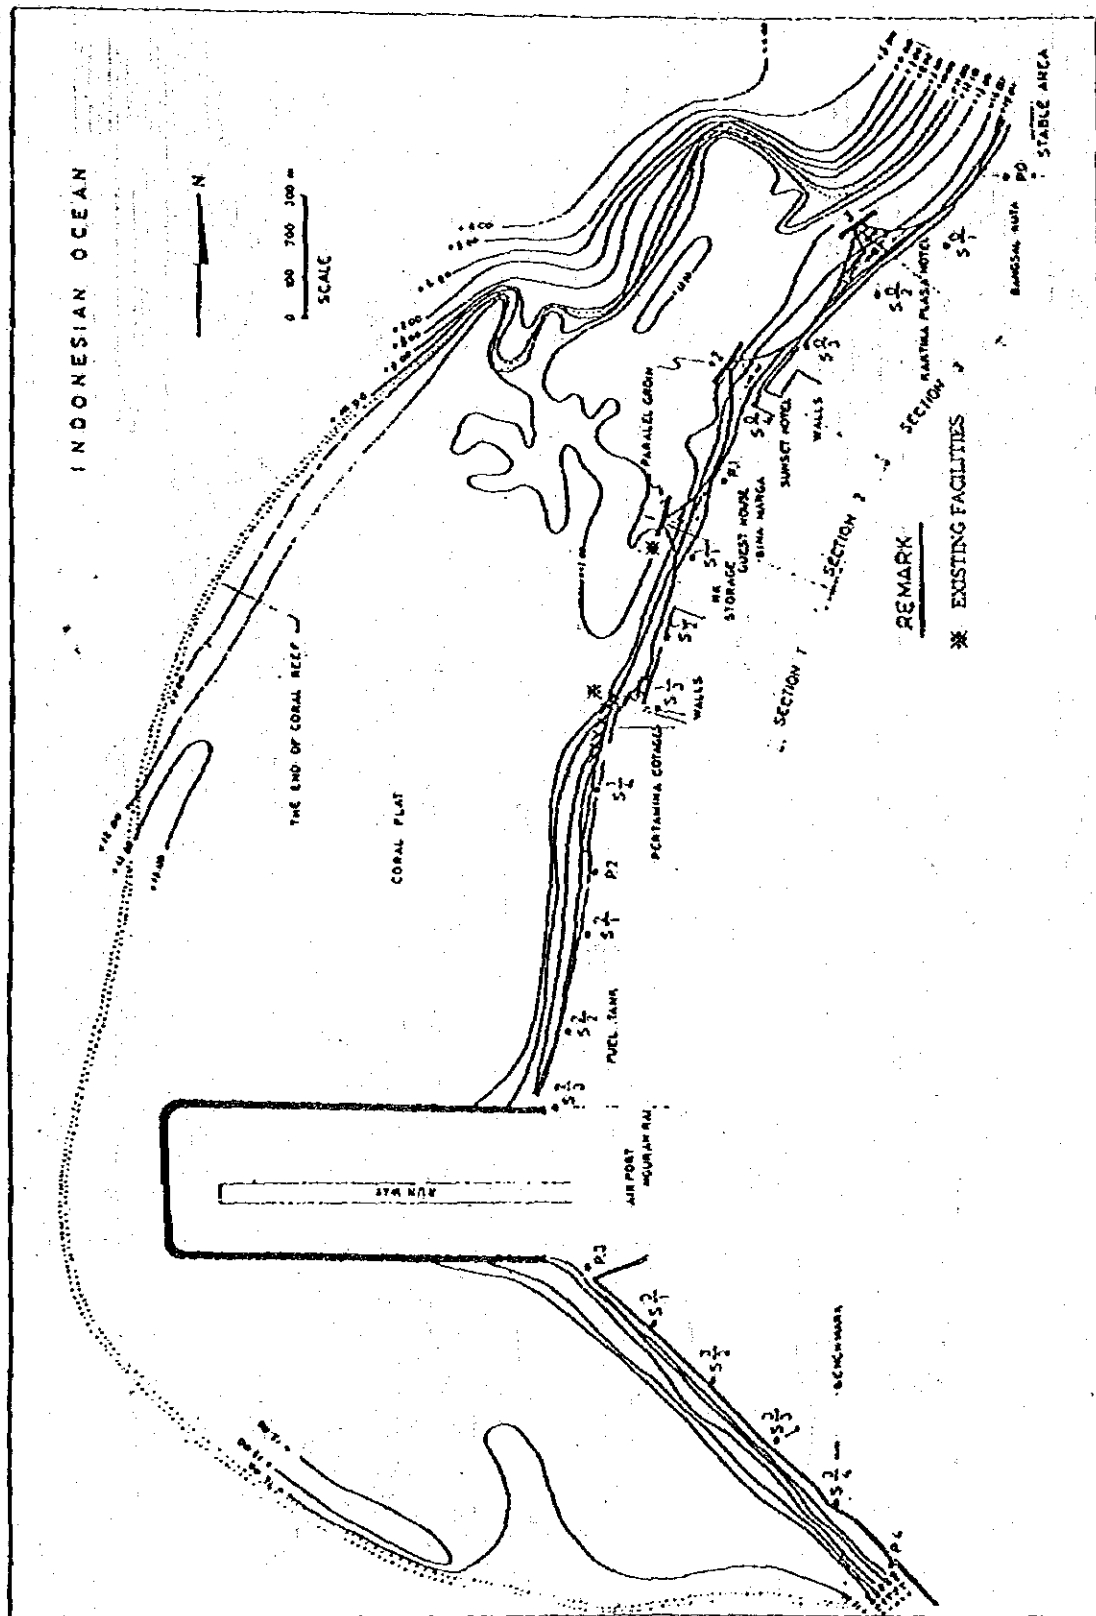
クタ海岸保全施設配置図及び施設配置計画図
